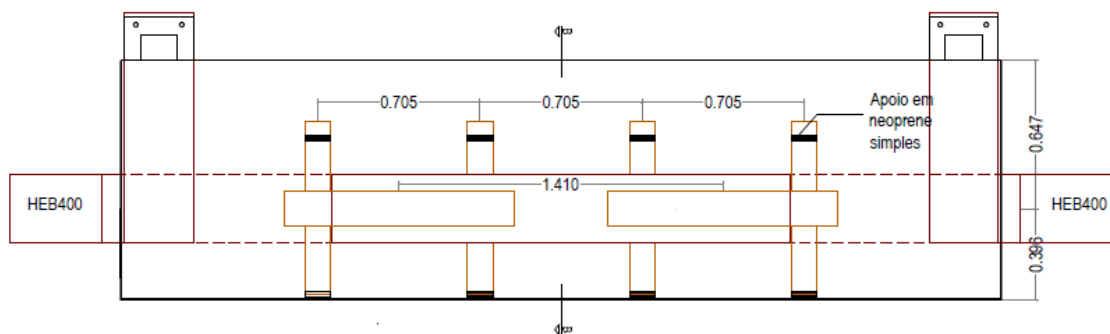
Corte A-A da Figura 5.10. Vista superior do esquema de ensaio (dimensões em m)
